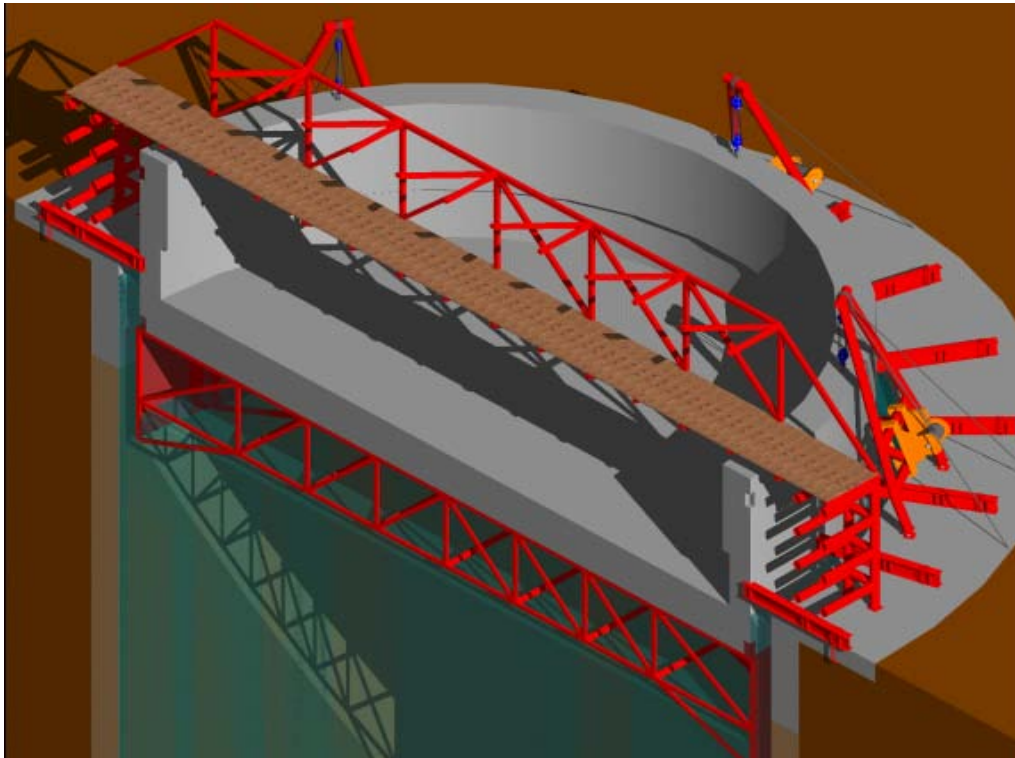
Corte de proceso de elaboración de muro e inmersión.
